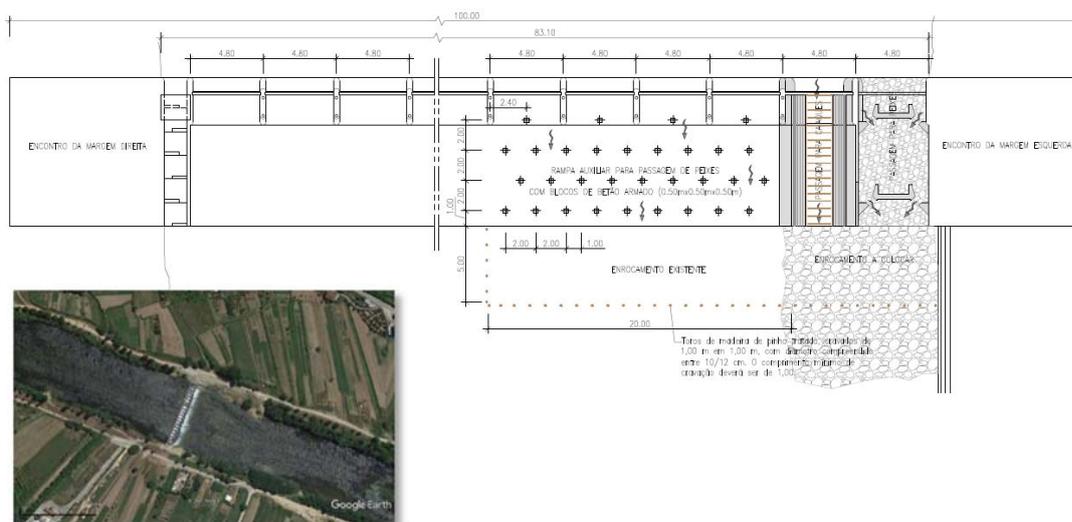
Passagens para peixes e caiaques construídas no açude do Reconquinho. Vista em planta. Vista aérea com o local da intervenção assinalado.
